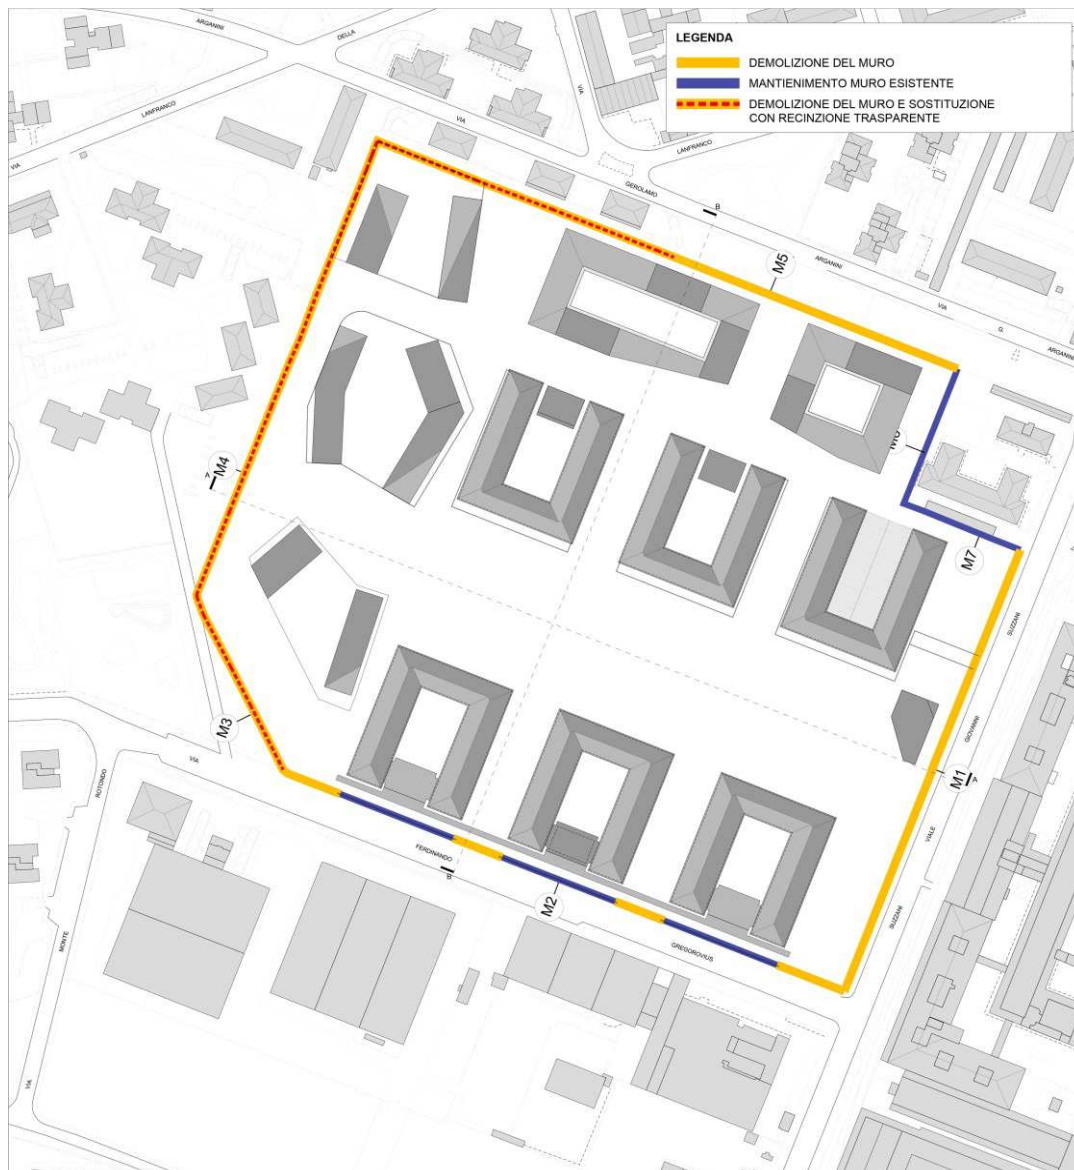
Progetto di intervento sulla muratura perimetrale
